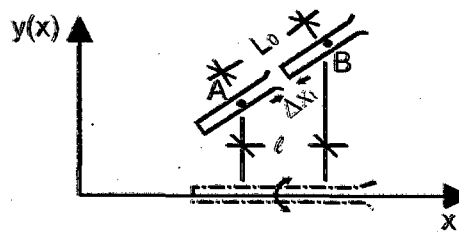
Vista en Planta de la Extensión Longitudinal de Tubería Segmentada sujeta a DPS Transversal
